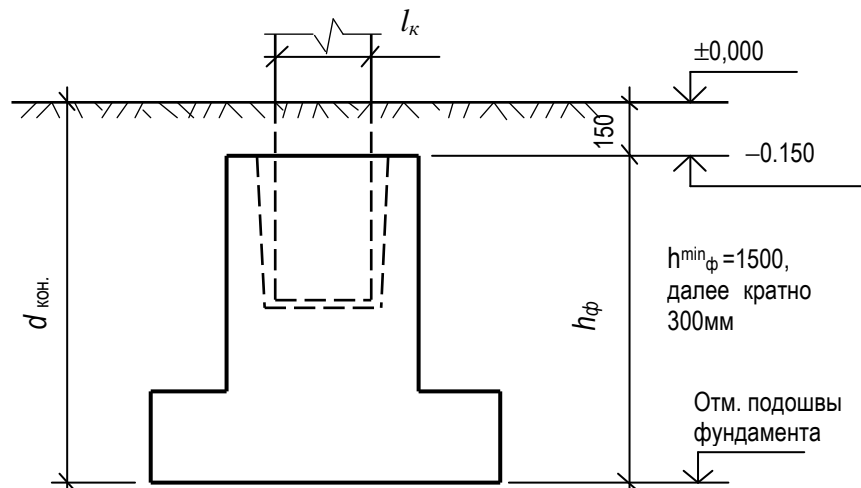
Предварительное конструирование отдельного (столбчатого), монолитного фундамента под сборную железобетонную колонну.
